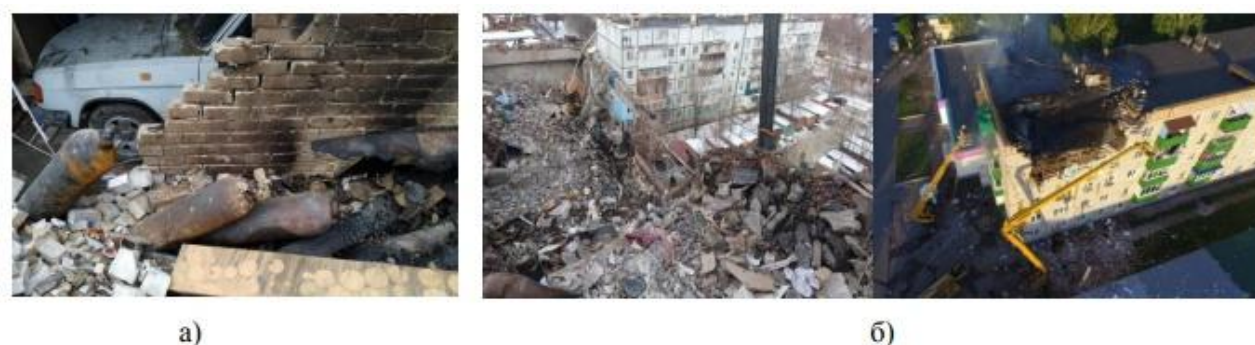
Примеры обрушения конструкций зданий: а – наружной стены; б – наружных и внутренних конструкций здания
